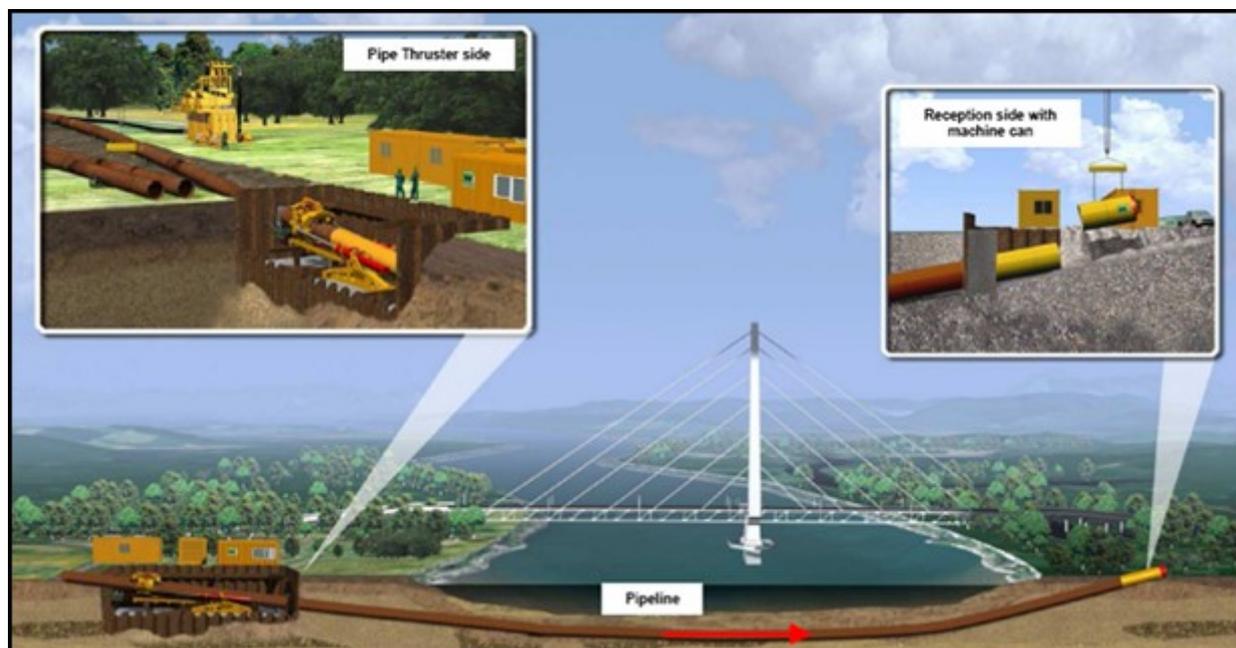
Schema di installazione mediante Direct Pipe.
